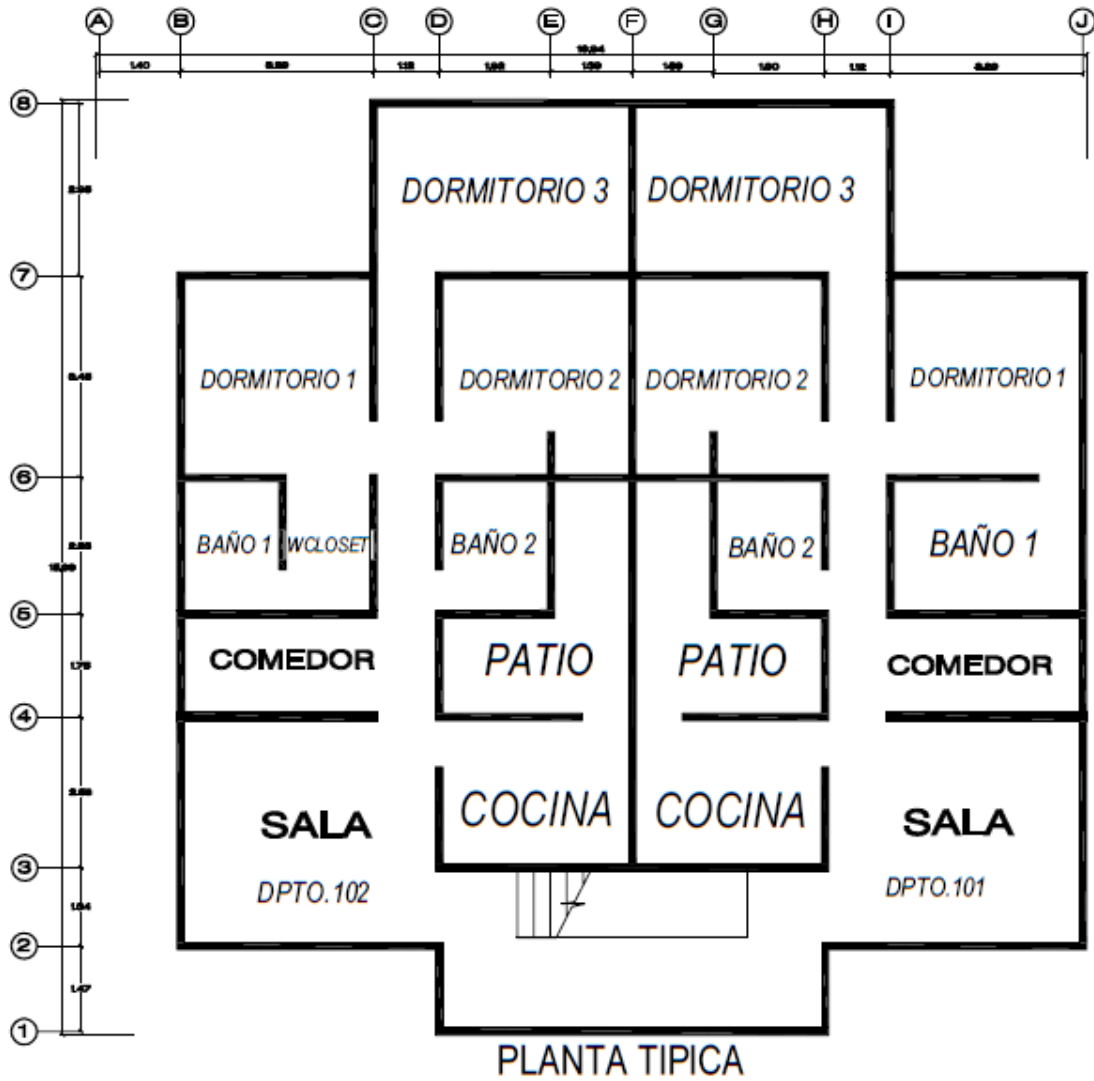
Planta Típica de la Edificación para los Modelamientos
